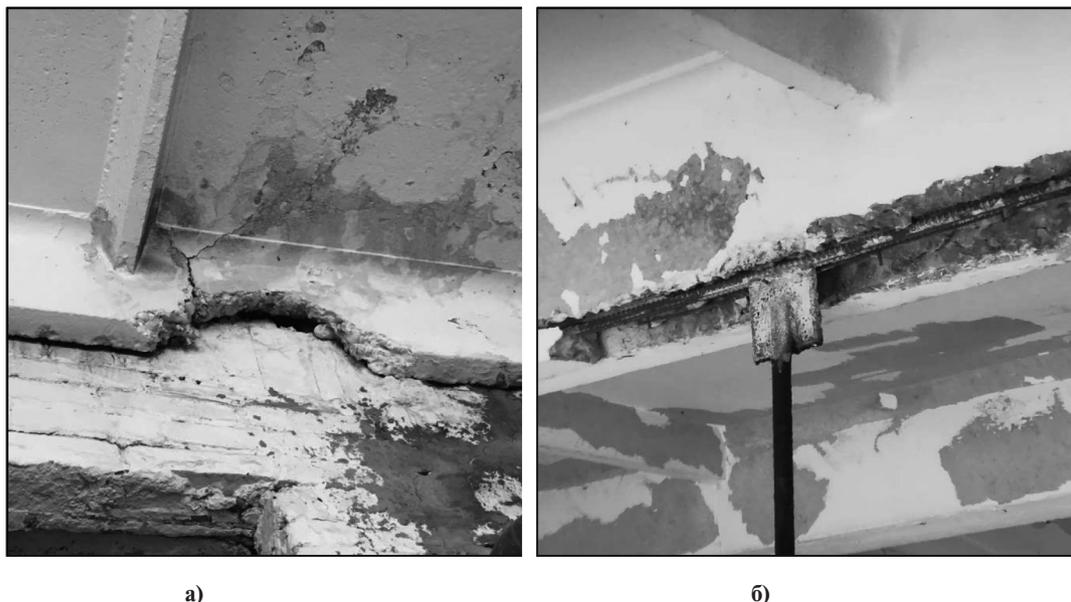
Повреждения поперечных ребер железобетонных плит:
